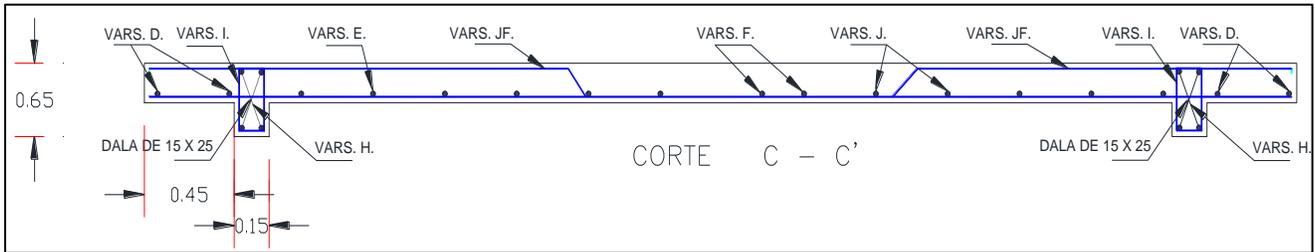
Detalle de armado de la losa corte C-C' en tanques de mampostería.
